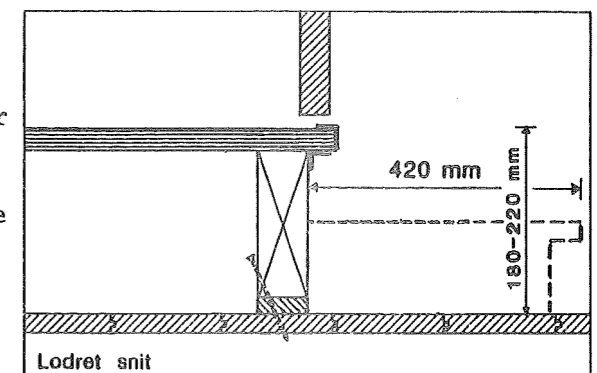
Tilslutning af hævet gulv til eksisterende gulv og væg. Undergulvets krydsfinérplade holdes 5 mm fra væg. Rammekonstruktionen sømnes gennem eventuel opklodsning til det eksisterende gulv.
